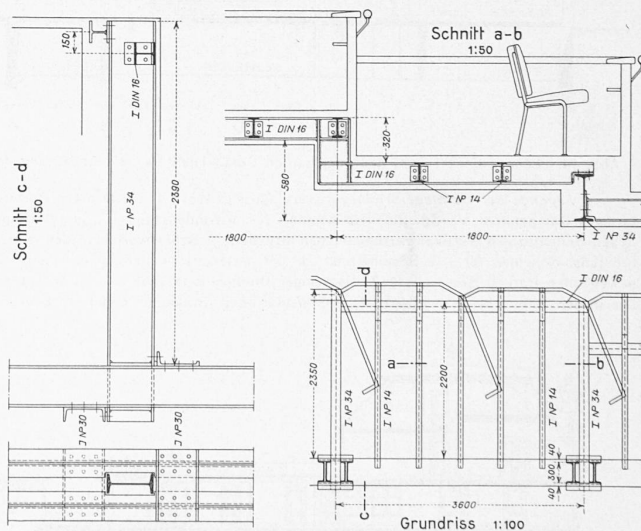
Konsolkonstruktion für die Balkonlogen. Grundriss 1 : 100, Schnitte 1 : 50.
